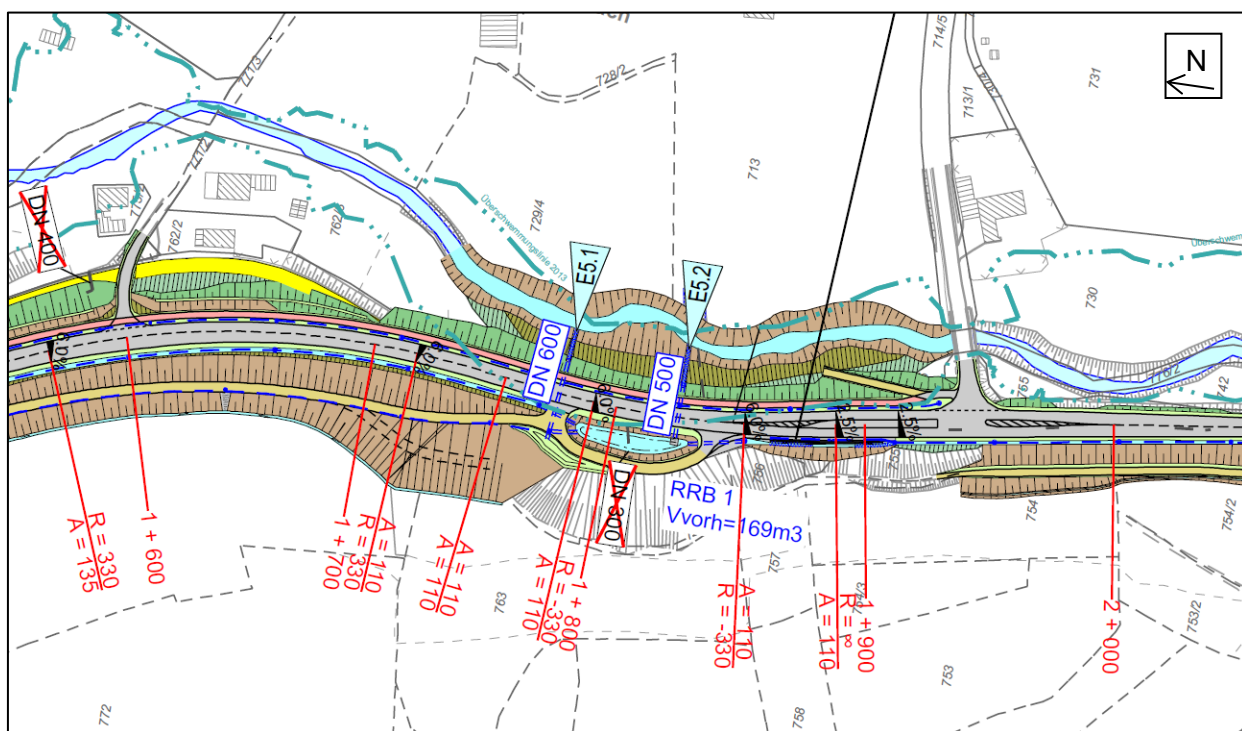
Auszug Lageplan 1, Abschnitt Gewässerverlegung (StBA Passau, 2020a)
